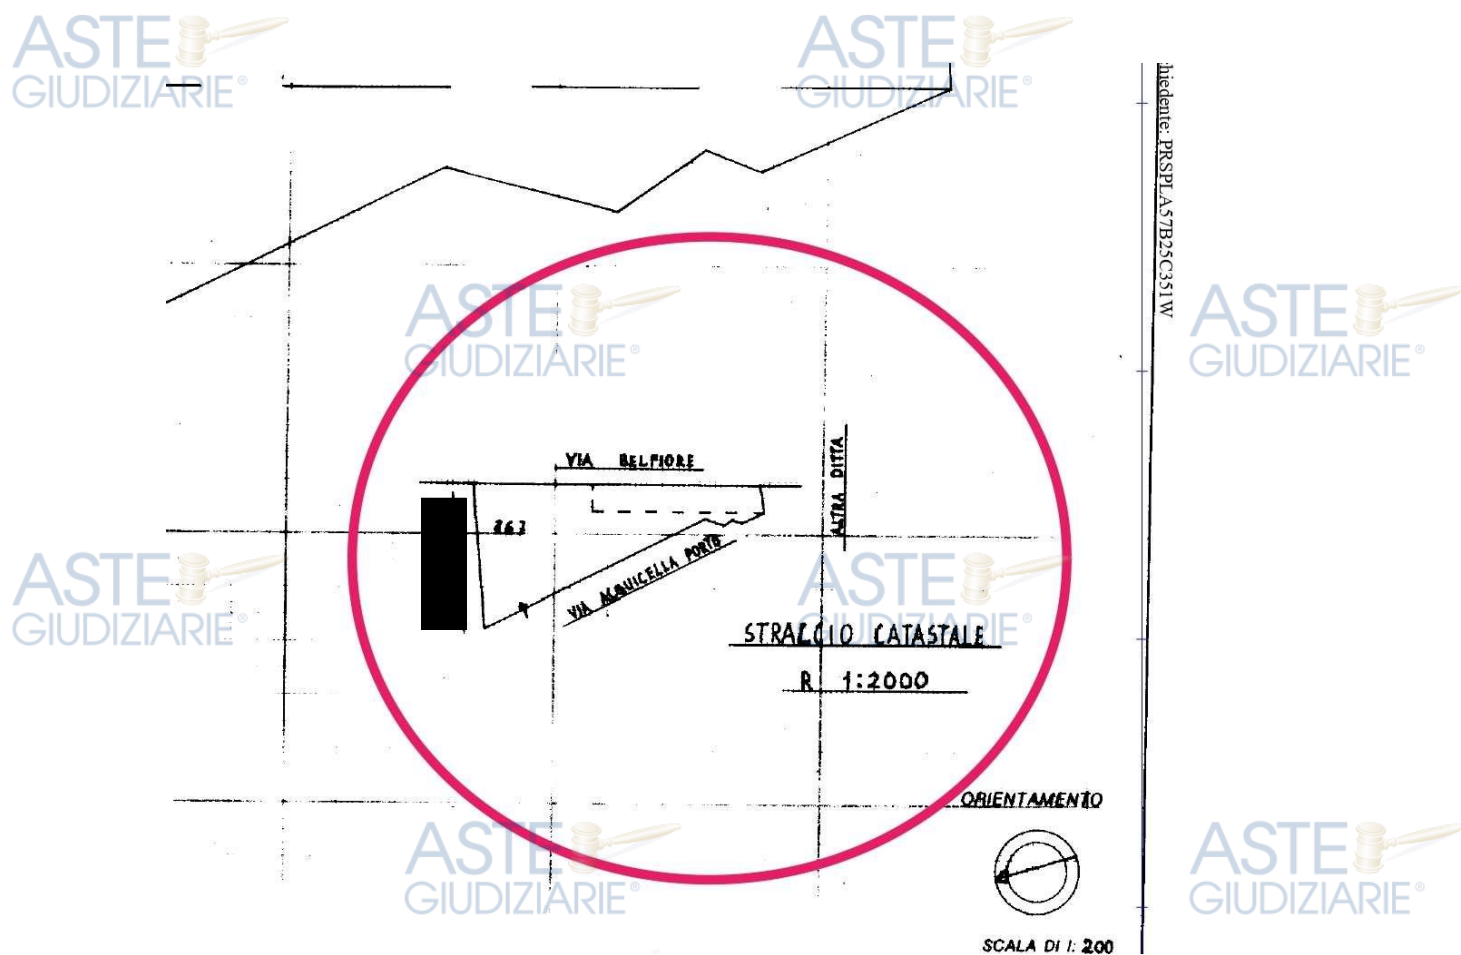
il particolare cerchiato difforme nella pianta catastale dell’u.i.u. staggita
